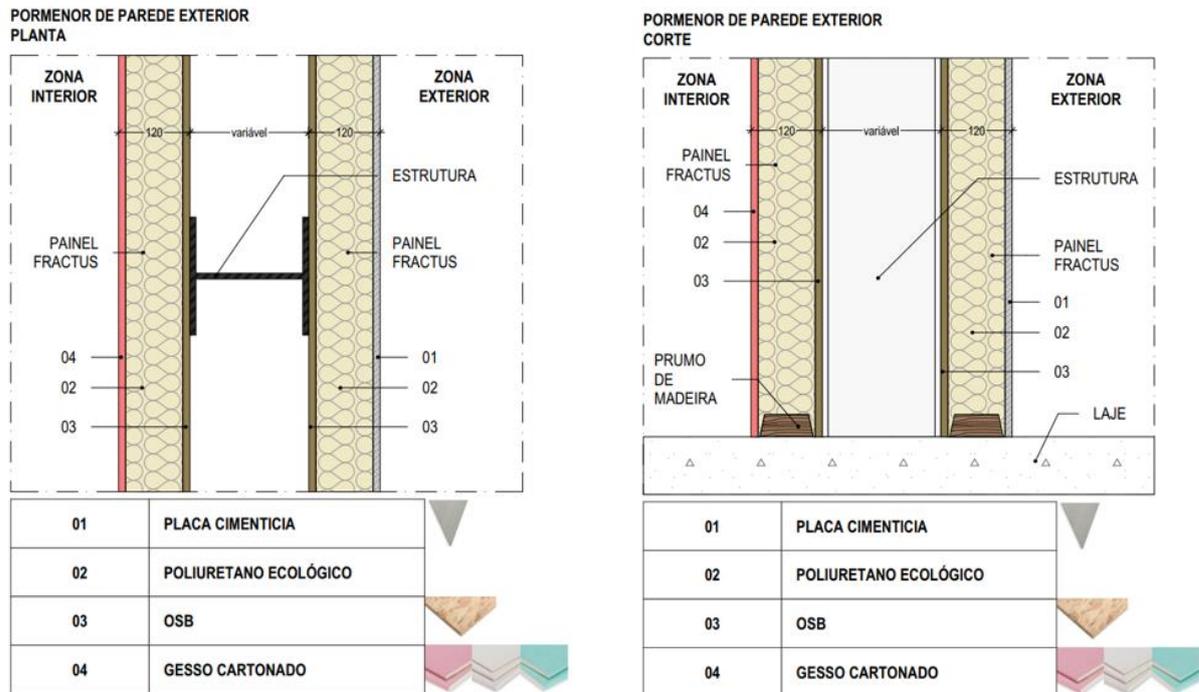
Pormenor de parede exterior. Fractus. 2023.
